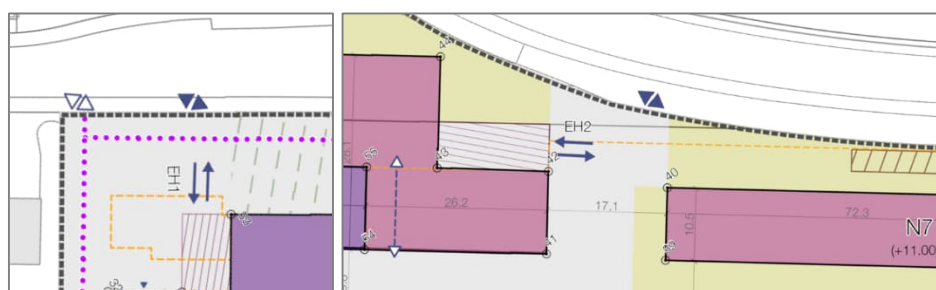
Areal-Zufahrten Ettiswilerstrasse (EH1) und Umfahrungsstrasse (EH2); Ein-/Ausfahrten Einstellhalle
